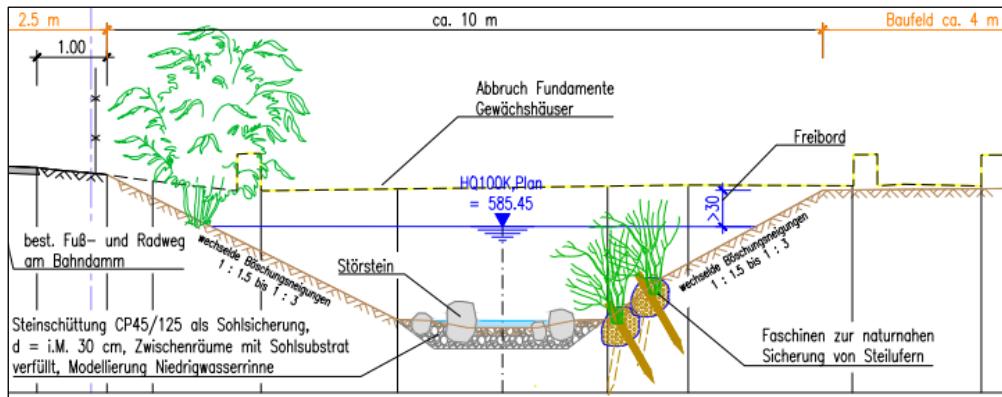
Querschnitt Wörthersbach Bereich 3.2, Planung (Quelle: IB Winkler Plan 004-1, Schnitt E-E)
